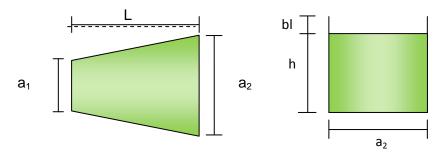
Vista en Planta y sección transversal de las Albercas biológicas
